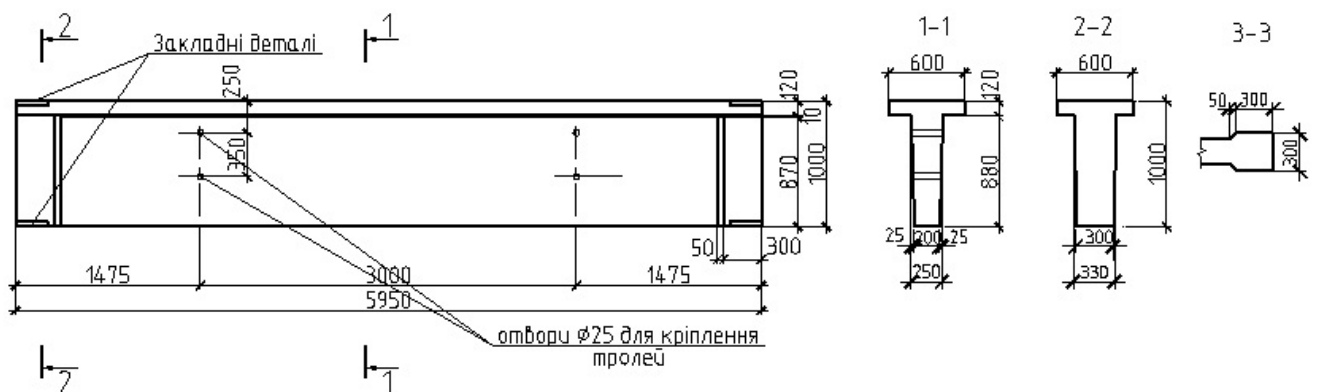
Опалубка підкранової балки прольотом 6 м
